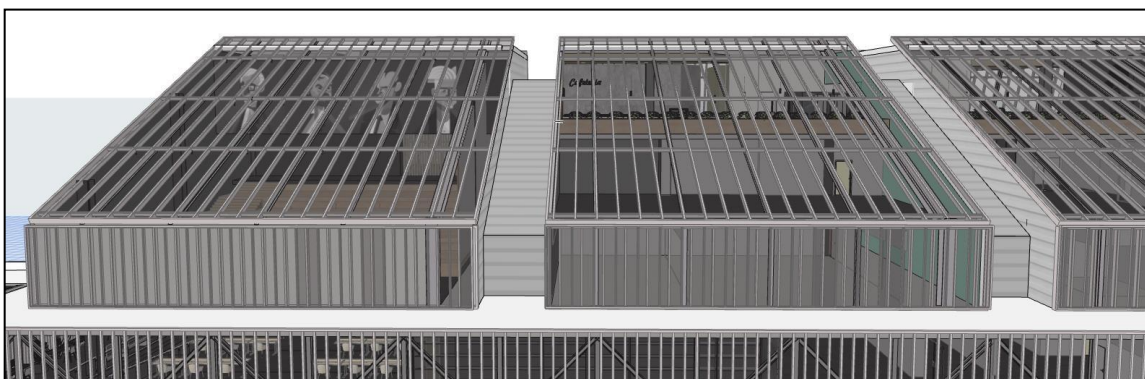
Modelado 3D (Fachada vidriada de Proyección)
